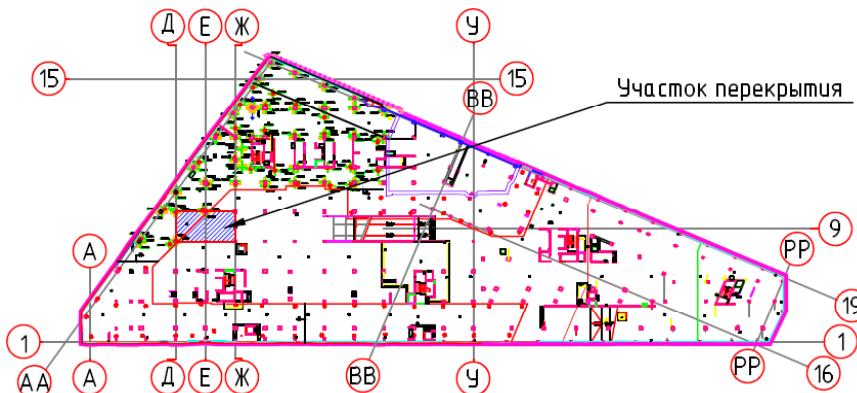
Схема расположения участка усиляемого перекрытия в габарите очей «8-10/Д-Ж» на отм. -8.100
